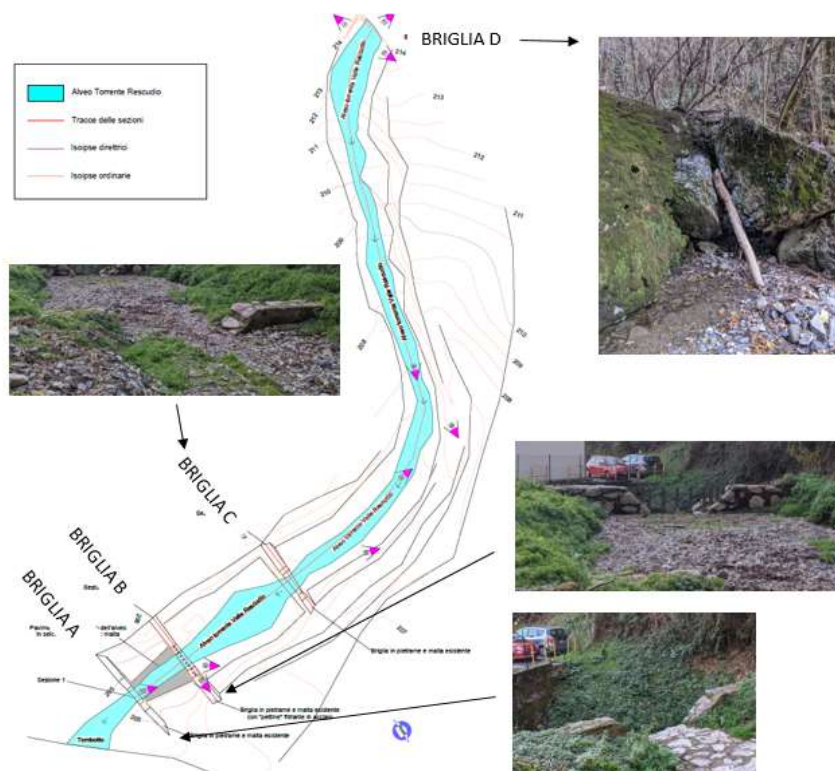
Stralcio della Tavola C.2 – Planimetria dello stato di fatto.
